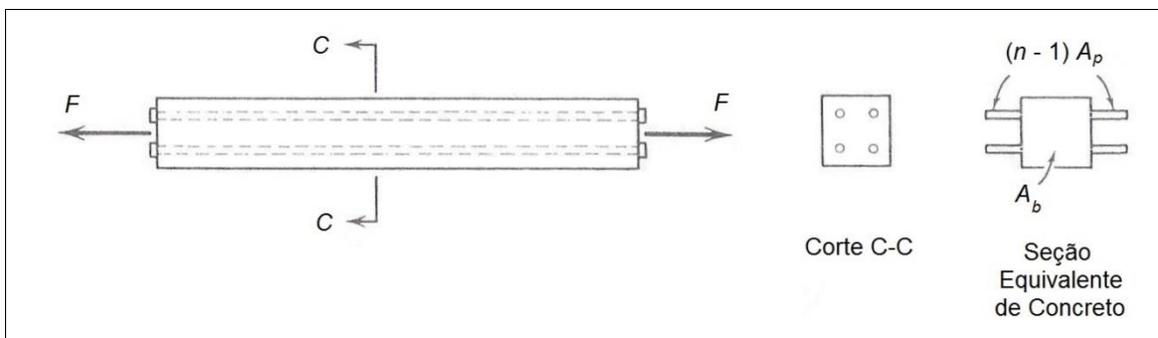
Tirante de concreto protendido [adaptado de Lin e Bruns (1982)].
